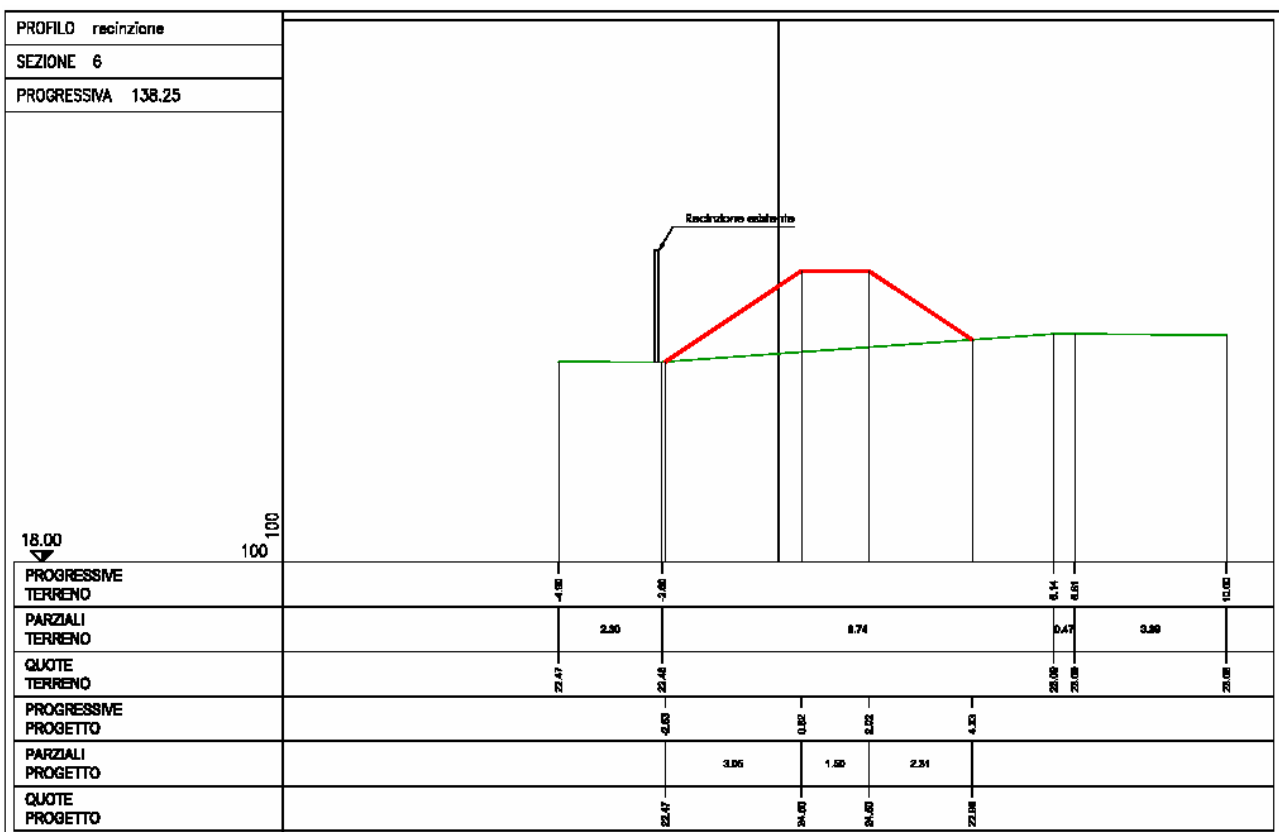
Sezione di rilievo e di progetto del rilevato per la difesa dalle piene dell'impianto di depurazione.
